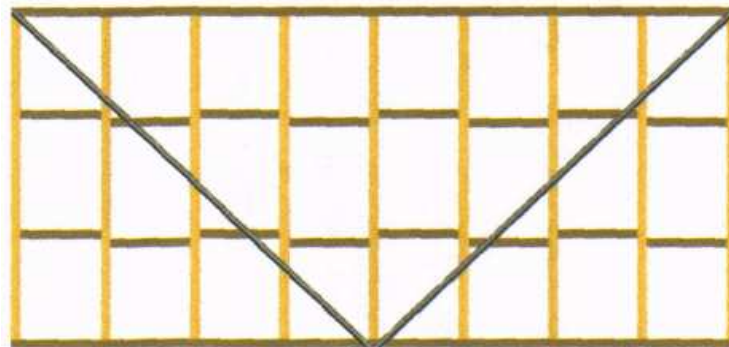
Entramado vertical arriostrado por medio de tensores en barras de acero plano
